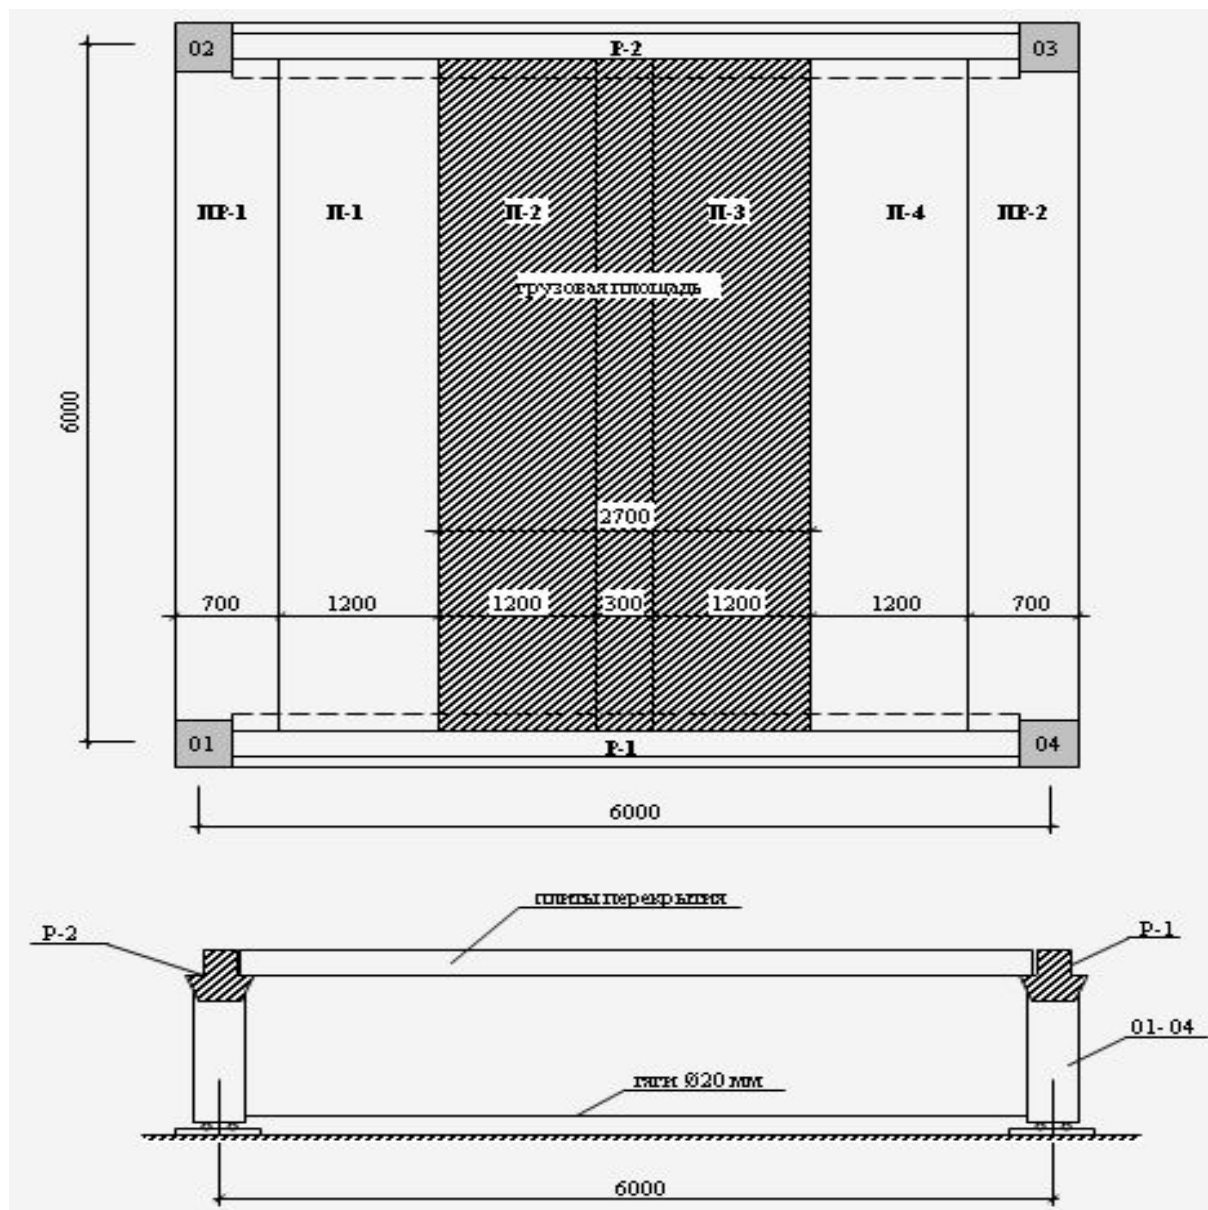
Фрагмент сборного железобетонного перекрытия
